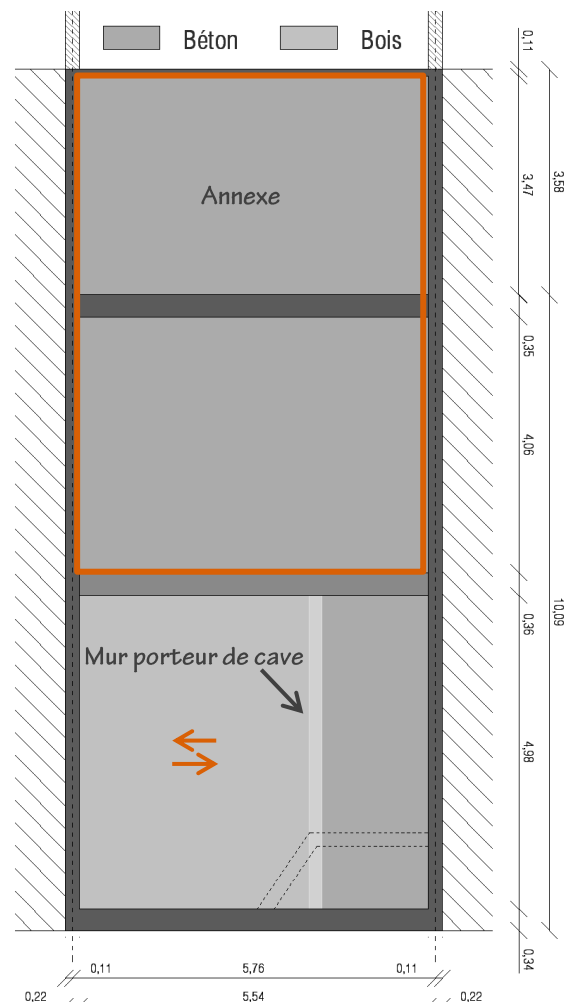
Plan schématique de la structure du plancher du rez-de-chaussée, mesures en [m]
